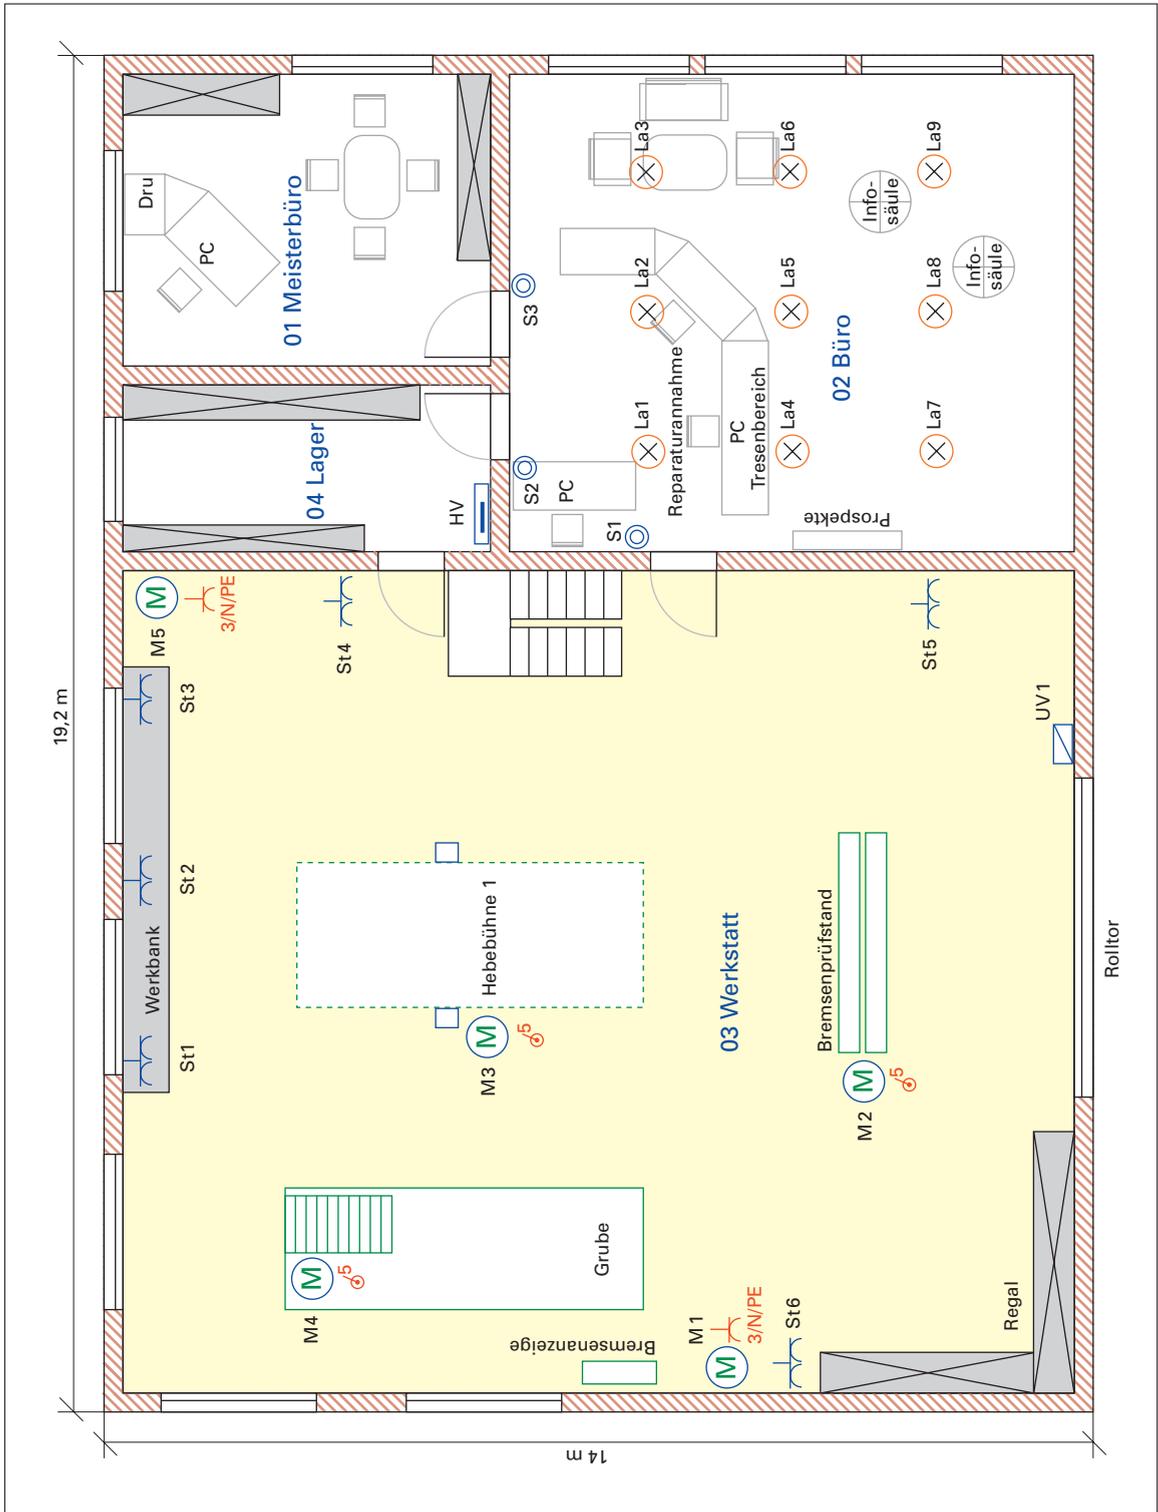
Installationsplanung der Kfz-Werkstatt (Anlage A 1.1)
